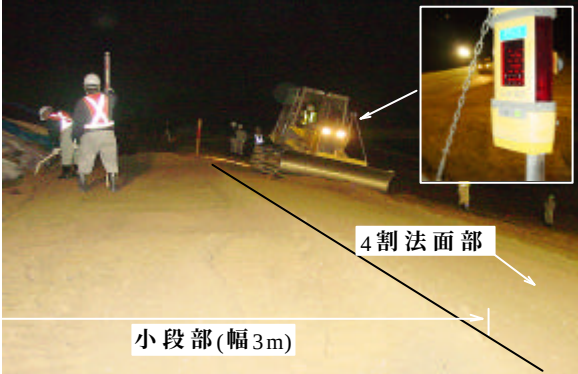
レーザーレベルを装着したブルドーザー敷均し状況
